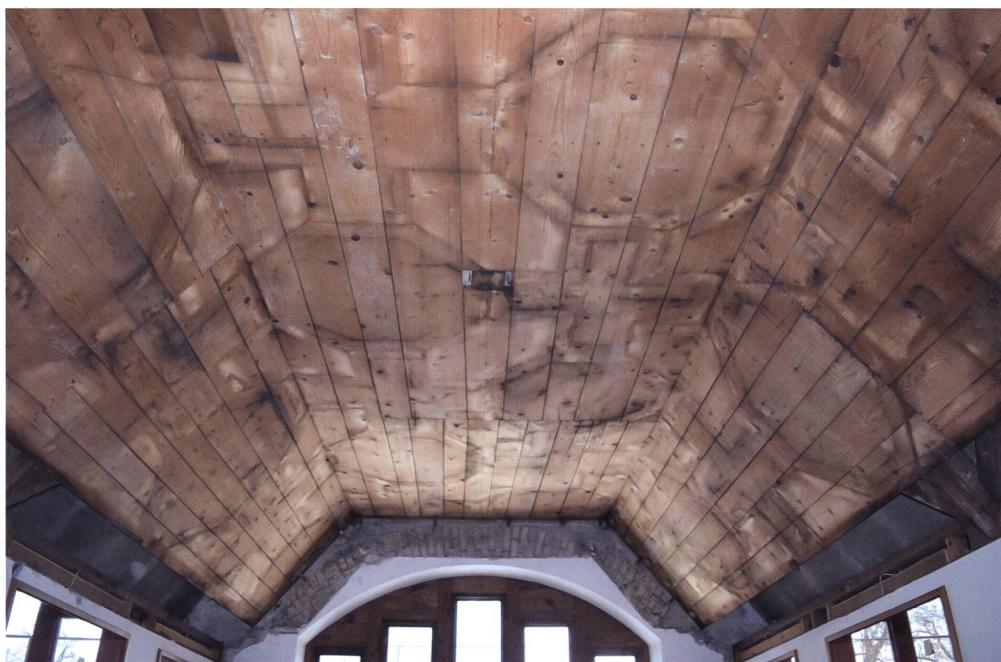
Durchgehende hölzerne Blinddecke, die auf einer darunterliegenden Rahmenkonstruktion montiert ist. Decke aus dem Winkelriedhaus Stans, Landesmuseum Zürich.
